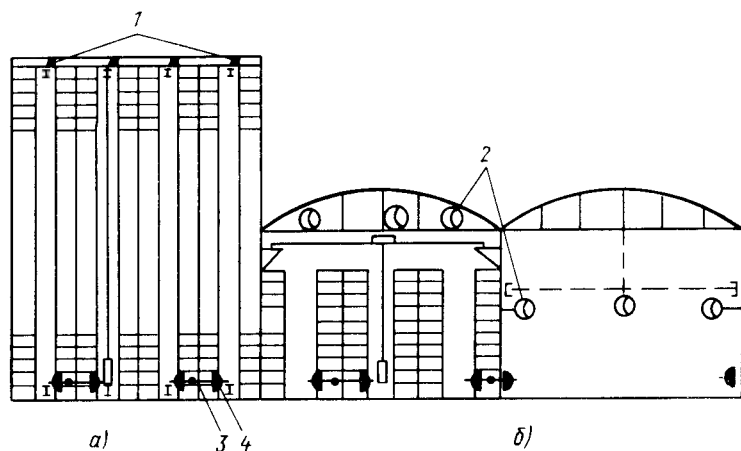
Освещение складов с кранами-штабелерами. Вариант установки светильников на перекрытии:
